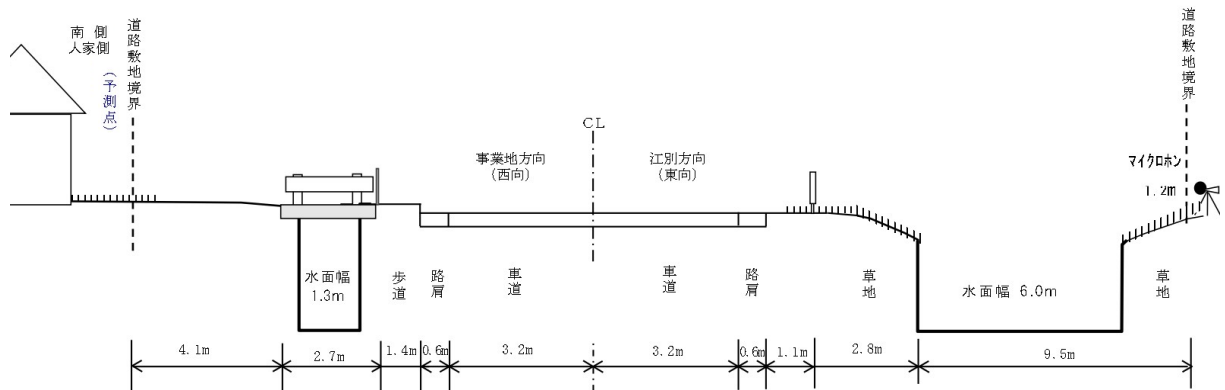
(3) 道路断面図 (K-3地点 市道8号幹道線(工場東側))
